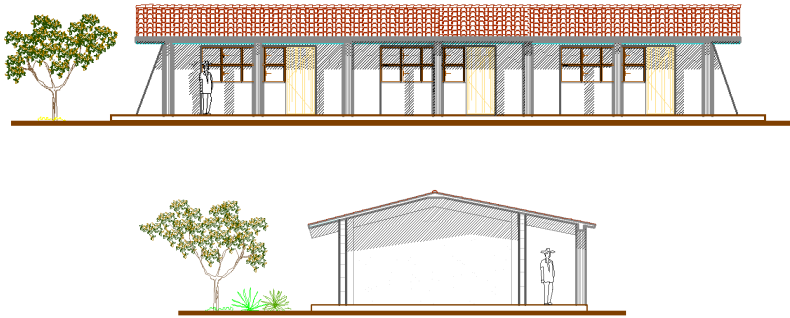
Proyecto Modulo de Aulas, Superior: fachada principal, Inferior: fachada lateral, se adiciona la teja como recubrimiento de la losa y el corredor en la parte frontal de las aulas
